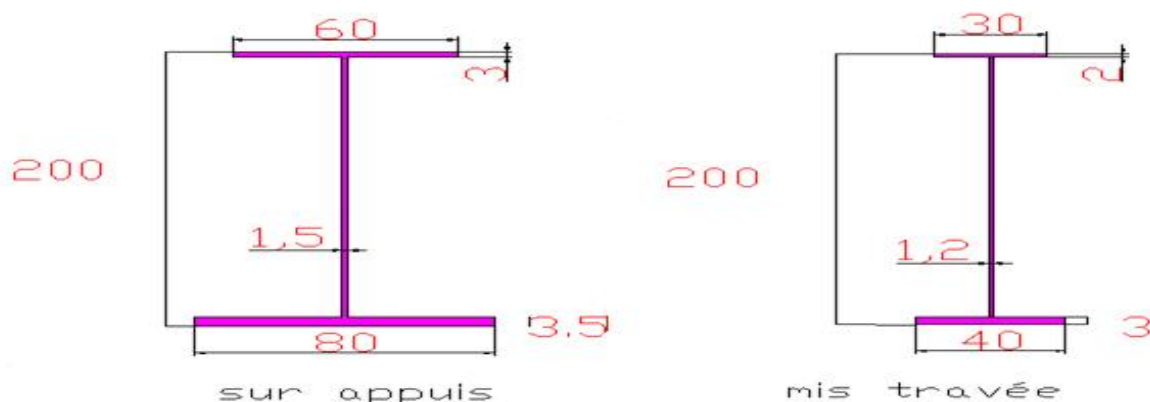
Profilé de poutre à mi-travée et sur appui
